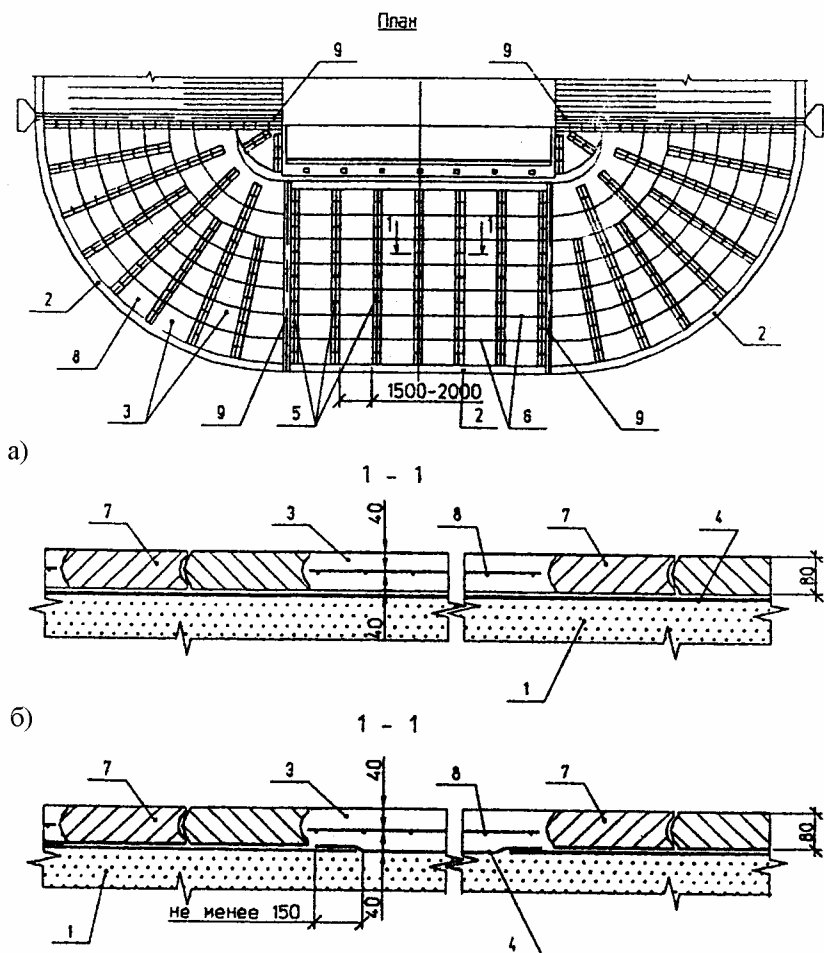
Сборно-моноконструкция укрепления конуса насыпи с применением ребристых плит (варианты укладки геотекстиля): а – за один прием в виде сплошной прослойки; б – в два приема; 1 – грунт конуса; 2 – бетонный упор; 3 – монолитное бетонное покрытие; 4 – геотекстильное полотно; 5 – продольные полосы из ребристых плит; 6 – поперечные элементы опалубки из антисептированных досок; 7 – ребристая плита; 8 – арматурная сетка; 9 – водосбросный лоток
